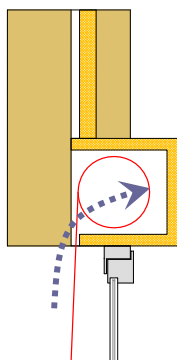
Sección tipo de capialzado montado en la hoja interior de la fachada. En azul, la principal vía de penetración del sonido a través de los capialzados
